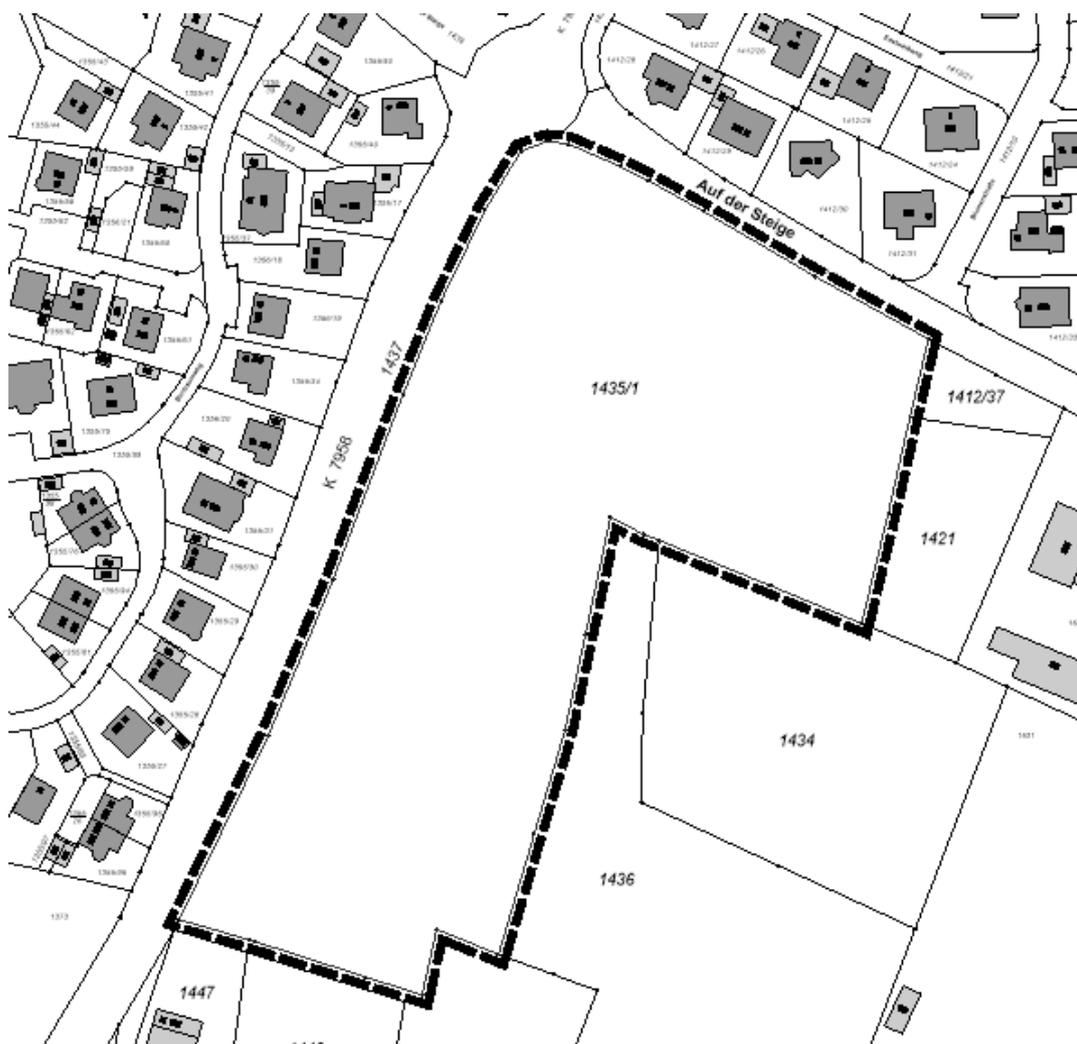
Lageplan mit Geltungsbereich, o. M.
